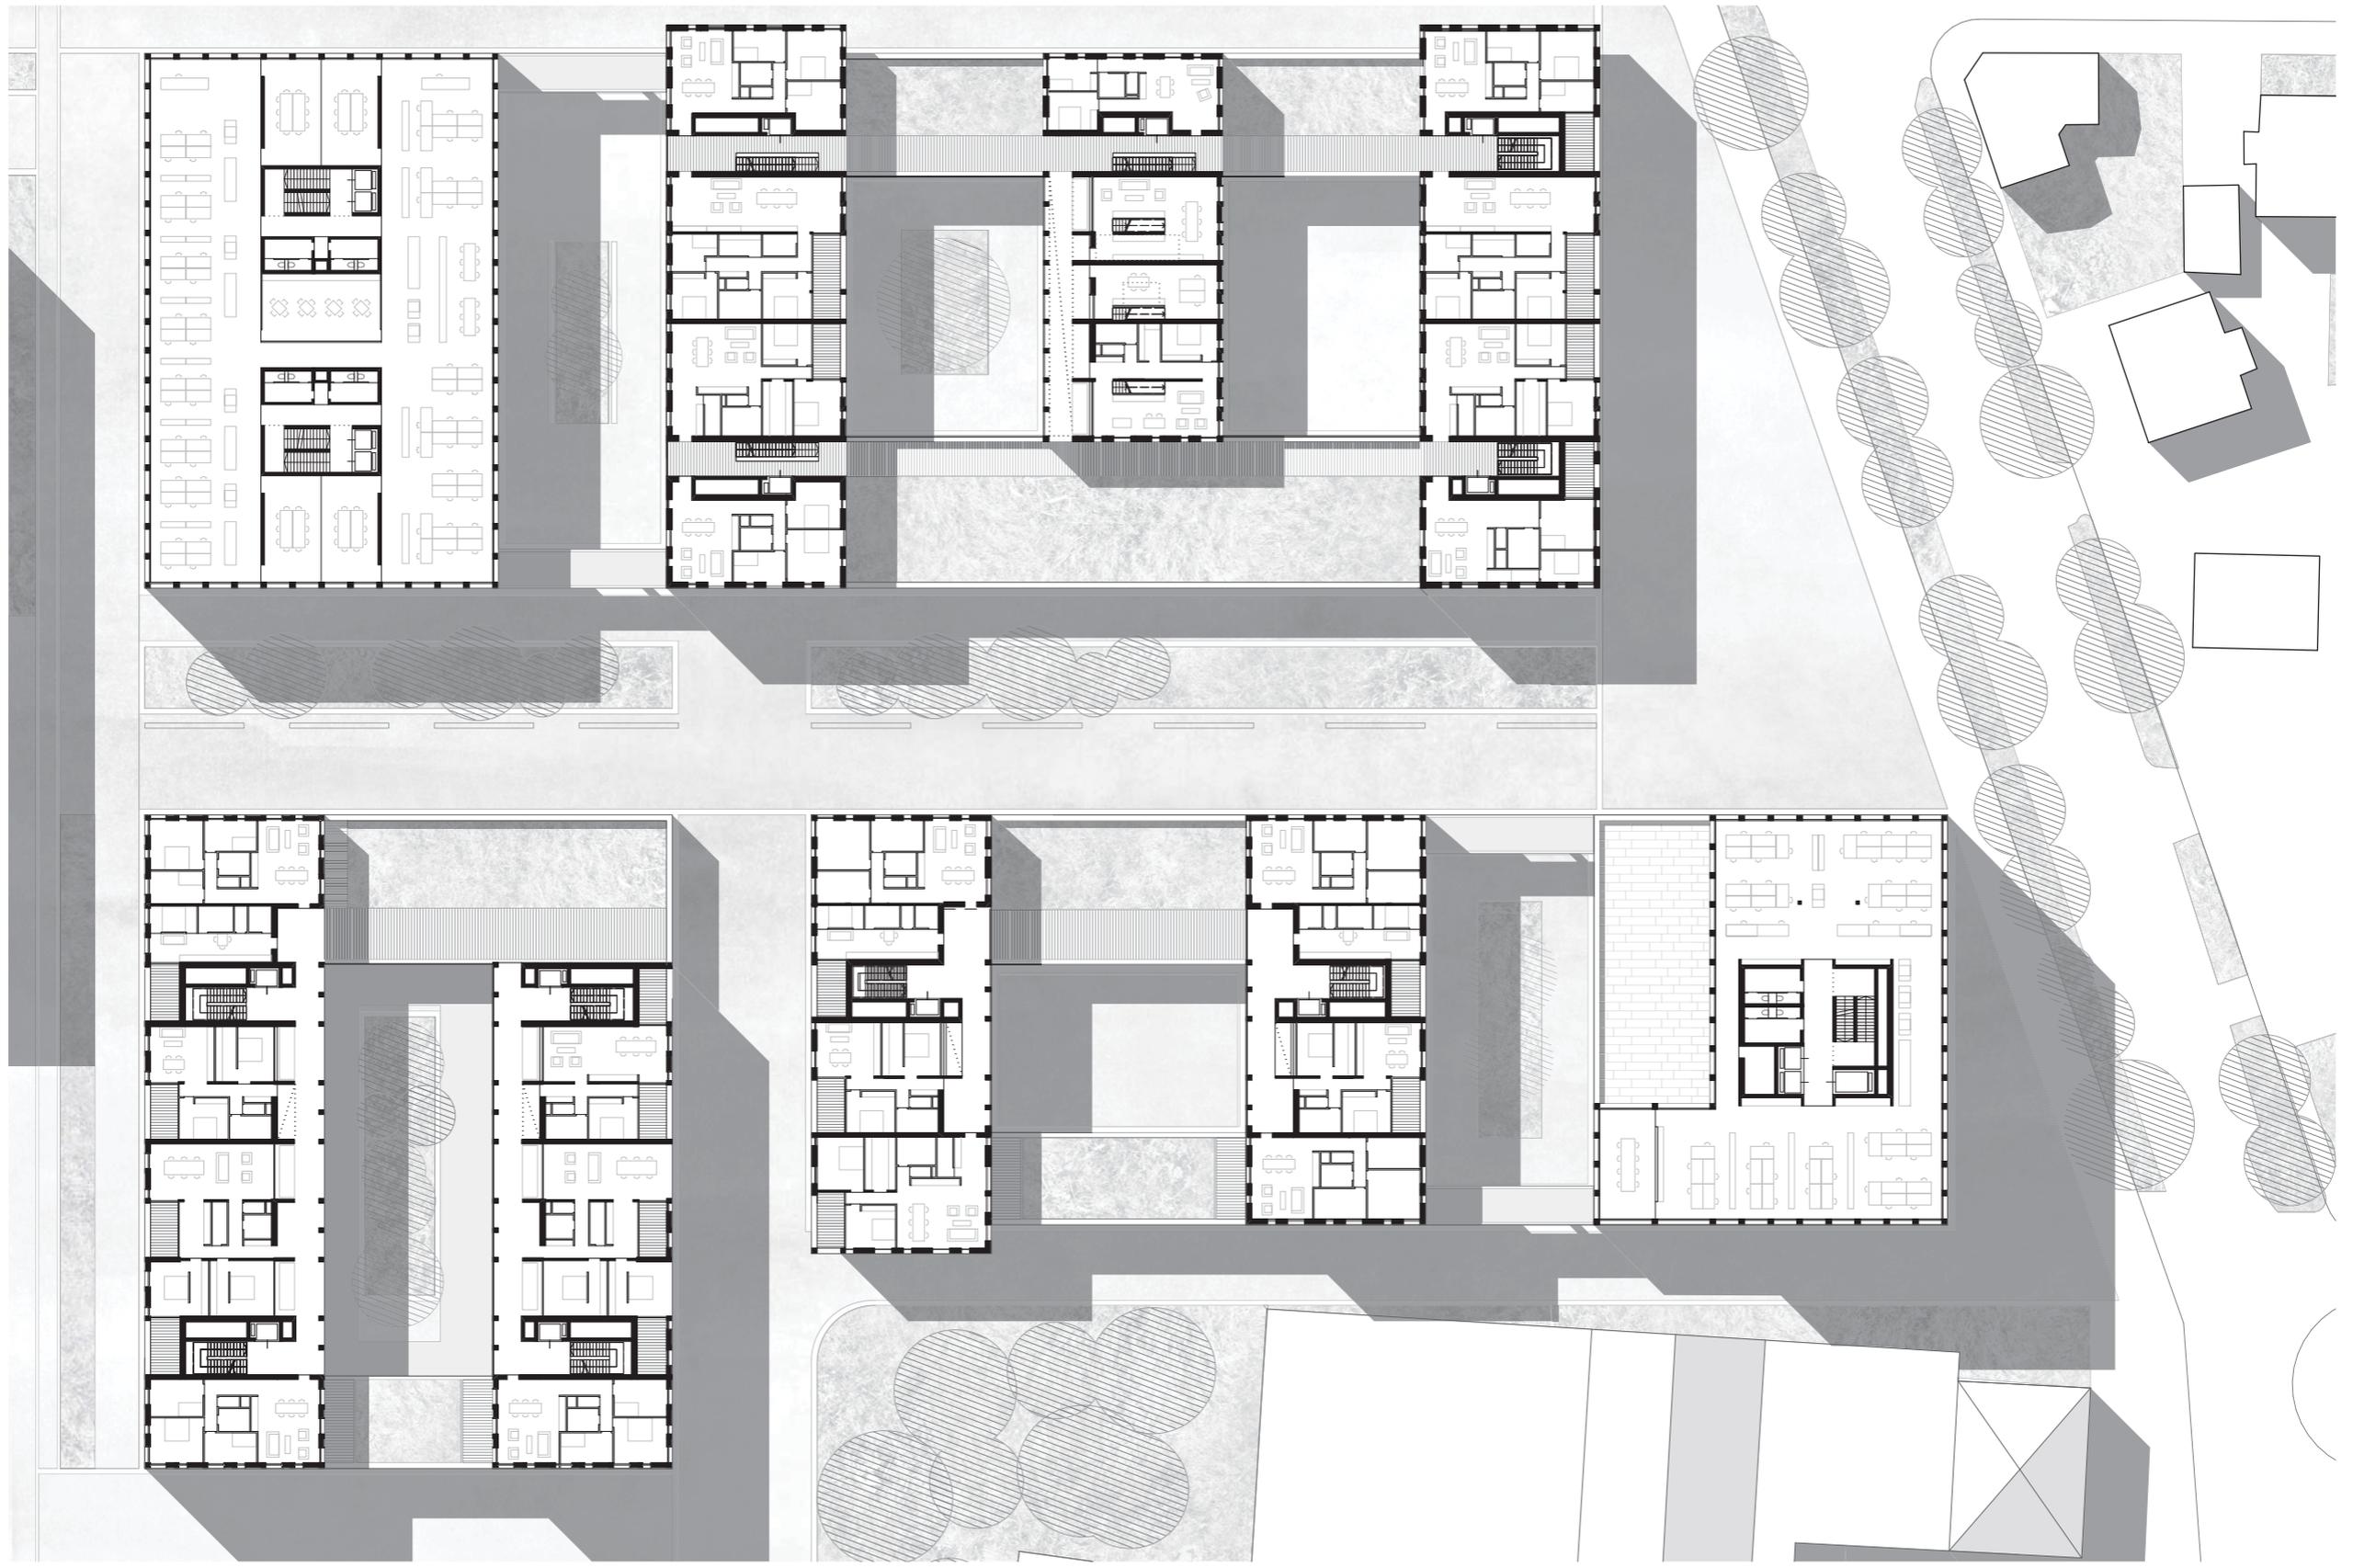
Grundriss 3. Obergeschoss, Ausschnitt Ost
